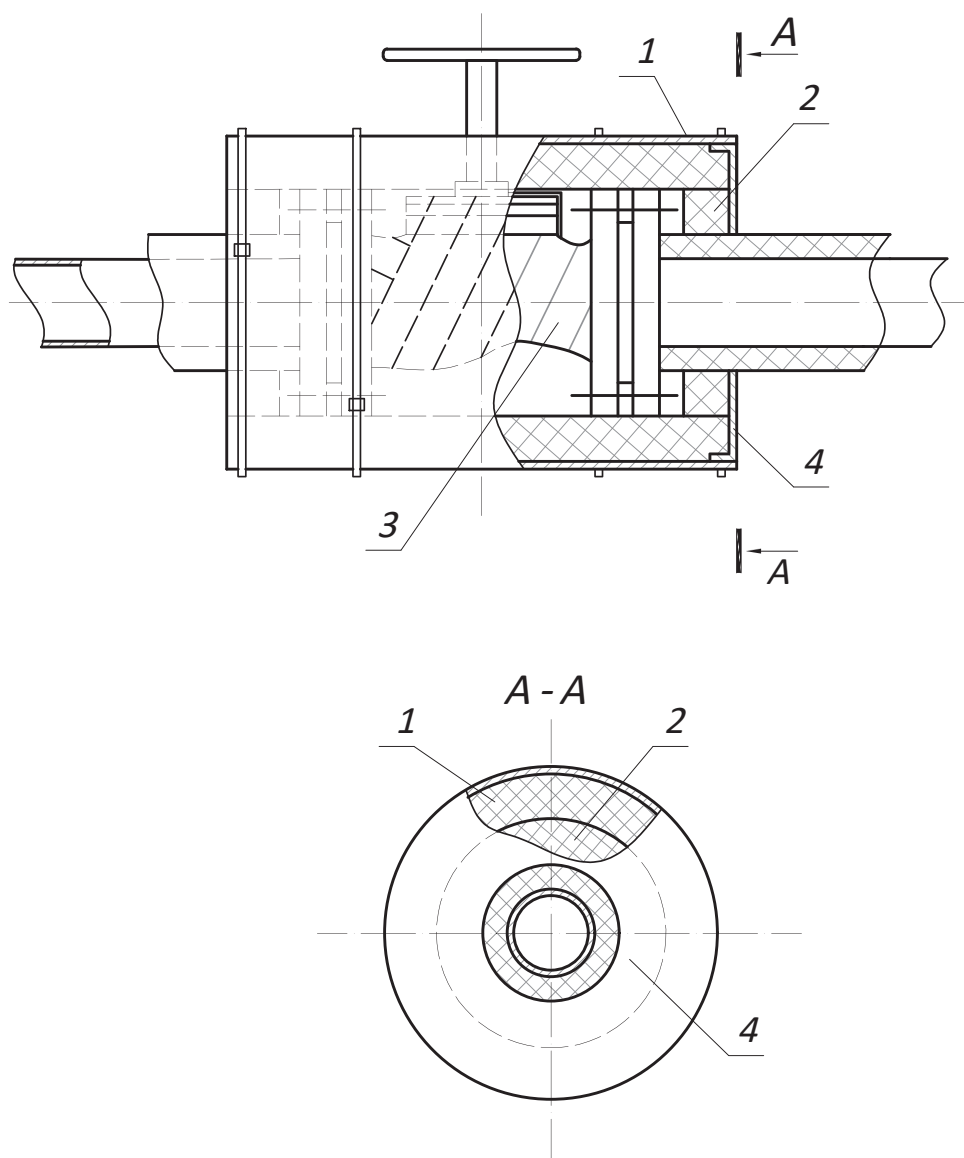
Несъемная тепловая изоляция фланцевой арматуры рулонными или листовыми изоляционными изделиями AEROFLEX без покрытий и с покрытиями ALU, FG, FG Alu, Metal Pro.
